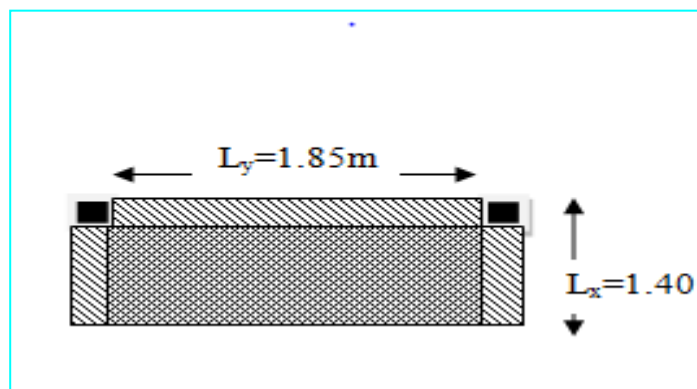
Schéma de ferrailage de la dalle sur quatre appuis
